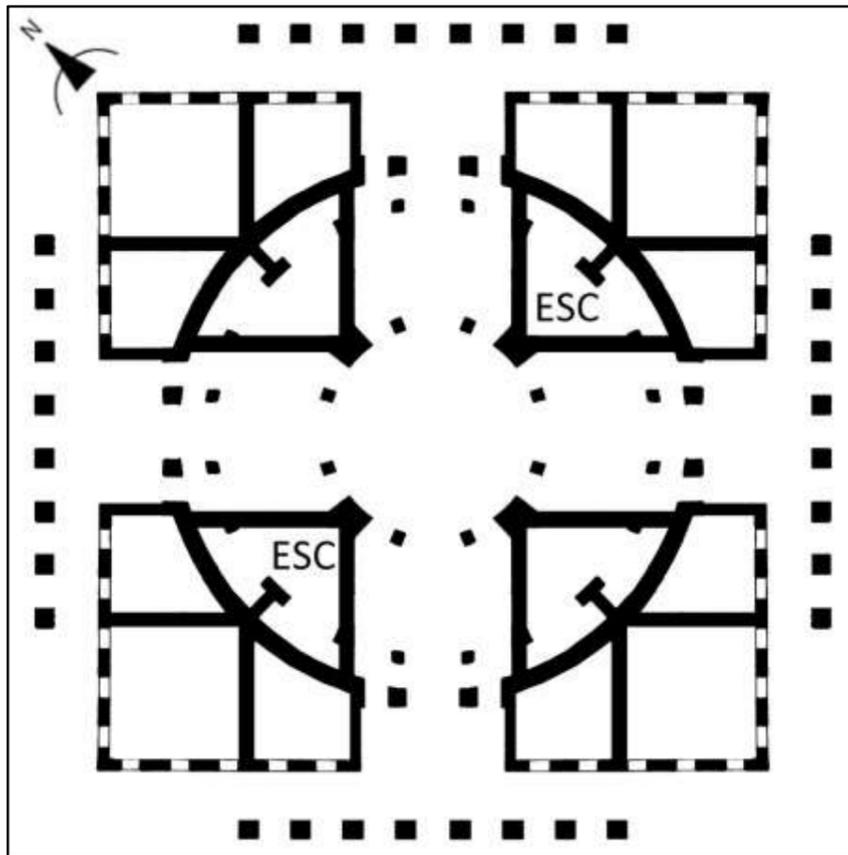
Plan du rez-de-chaussée de la rotonde.
